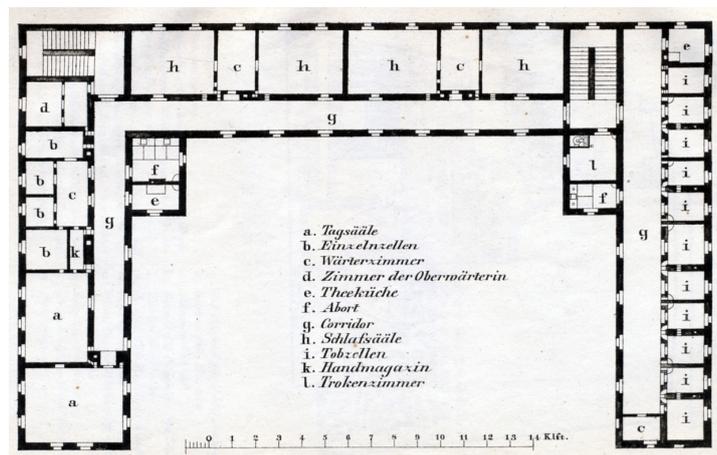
Grundriss erster Stock Gebäude ,e', Zubau für weibliche Kranke
